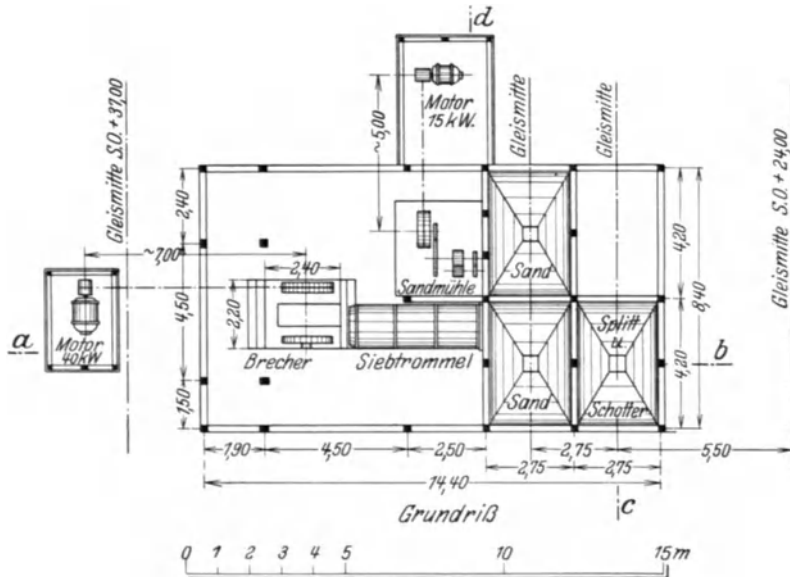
Grundriß einer Brech- und Mahlanlage für einen provisorischen Betrieb.
